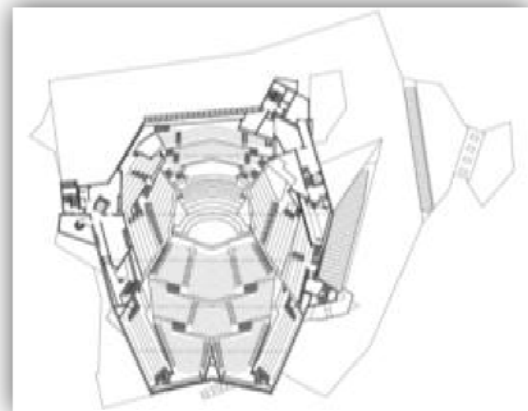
Planta arquitectónica. Sin escala. Fuente: berliner-philharmoniker.de.
